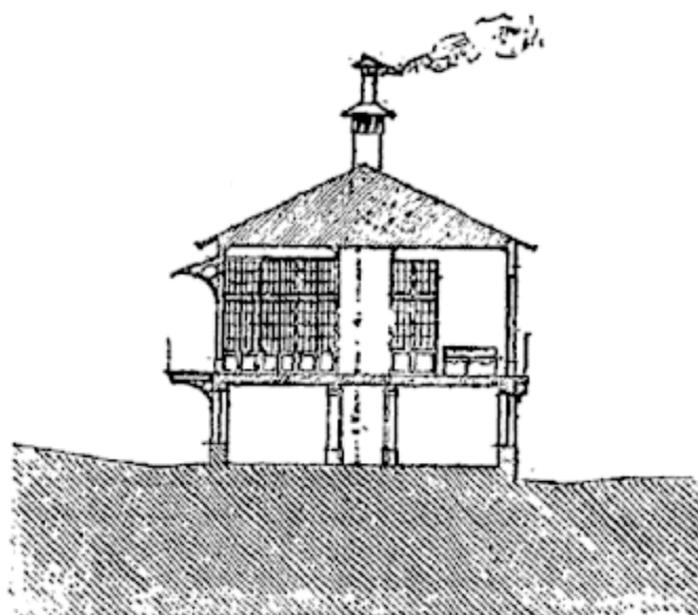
Coupe sur la ligne A B du plan (fig. 1).
